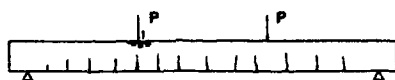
Grietas de flexión en la fase de rotura de una viga fuertemente armada (cuantía 5,1%). El espacio entre grietas ha disminuido considerablemente y hay indicios de aplastamiento del hormigón en el punto 1 al alcanzar allí la resistencia de compresión un valor excesivo. Citado por Bukowski.¹
